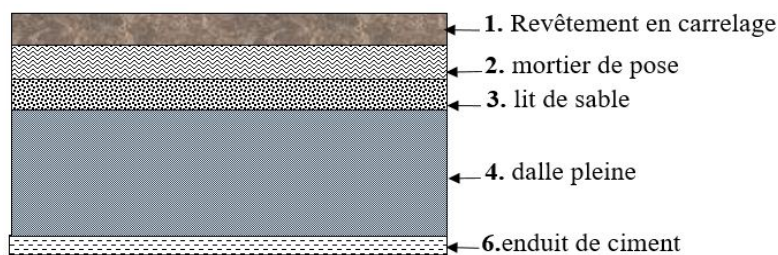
Coupe transversale dans le plancher à dalle pleine
